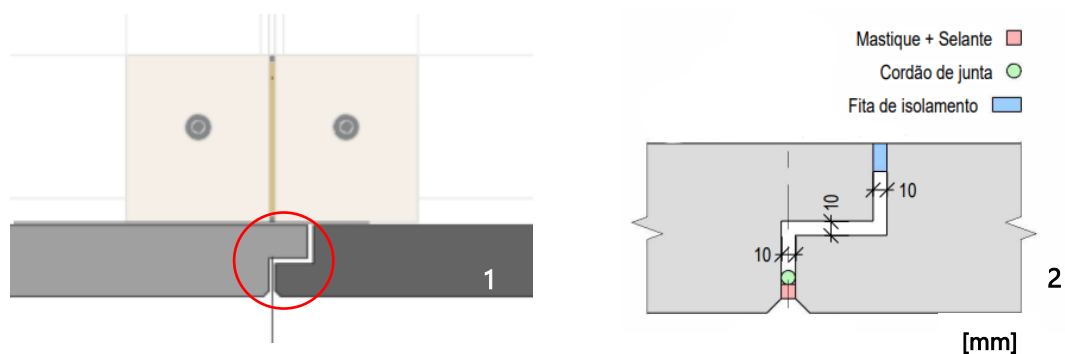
Pormenor de junta horizontal entre painéis de fachada (sem escala)
